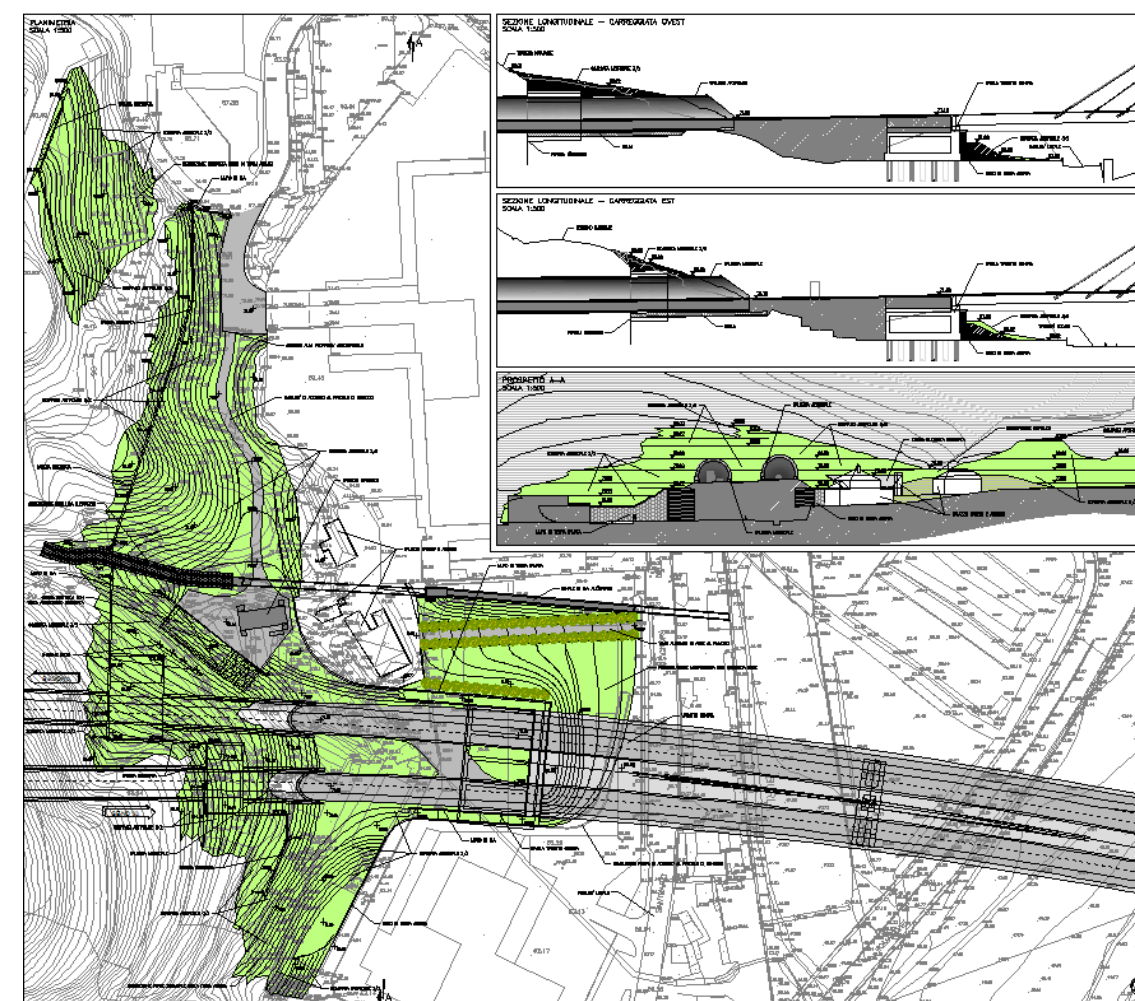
Imbocco galleria Monterosso - Sistemazione finale del progetto in Variante
